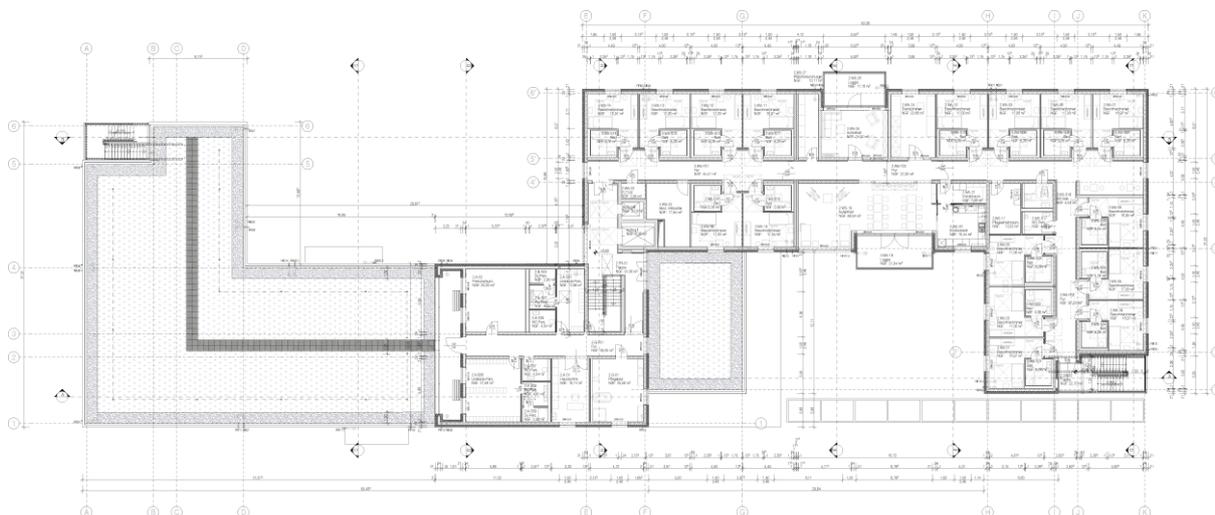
Grundriss II. OG _ Seniorenzentrum_HWR
